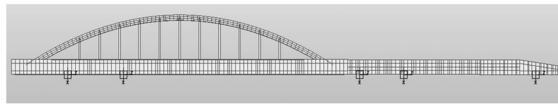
84 m 钢拱桥顶推施工时的最大正弯矩工况
